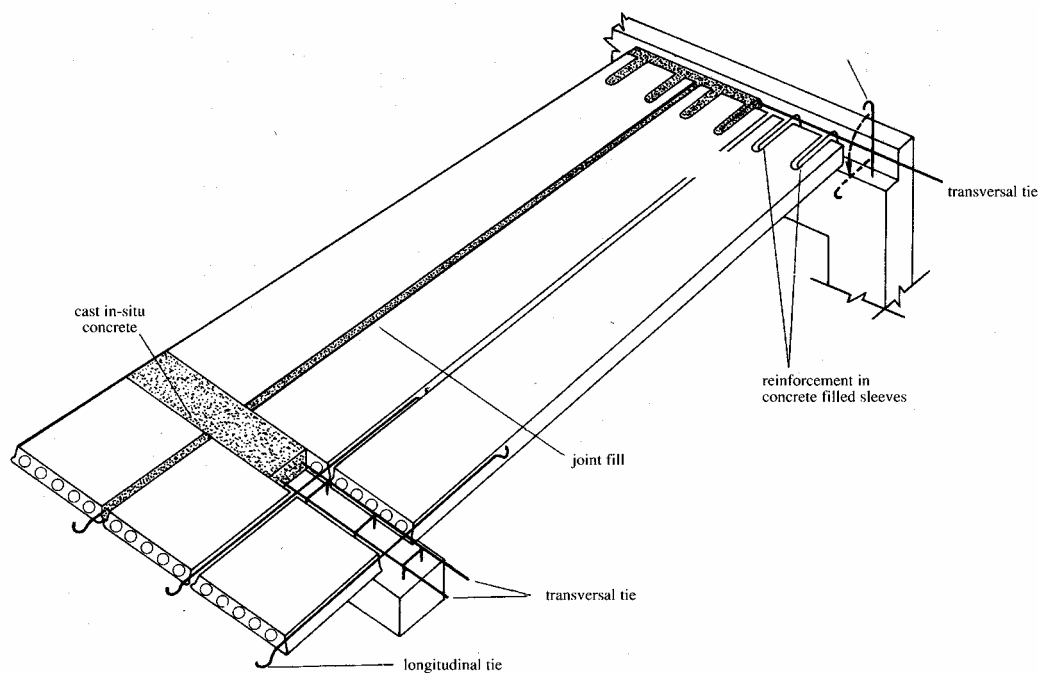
Ancoragem das barras de tirante longitudinais nos elementos de lajes alveolares.
